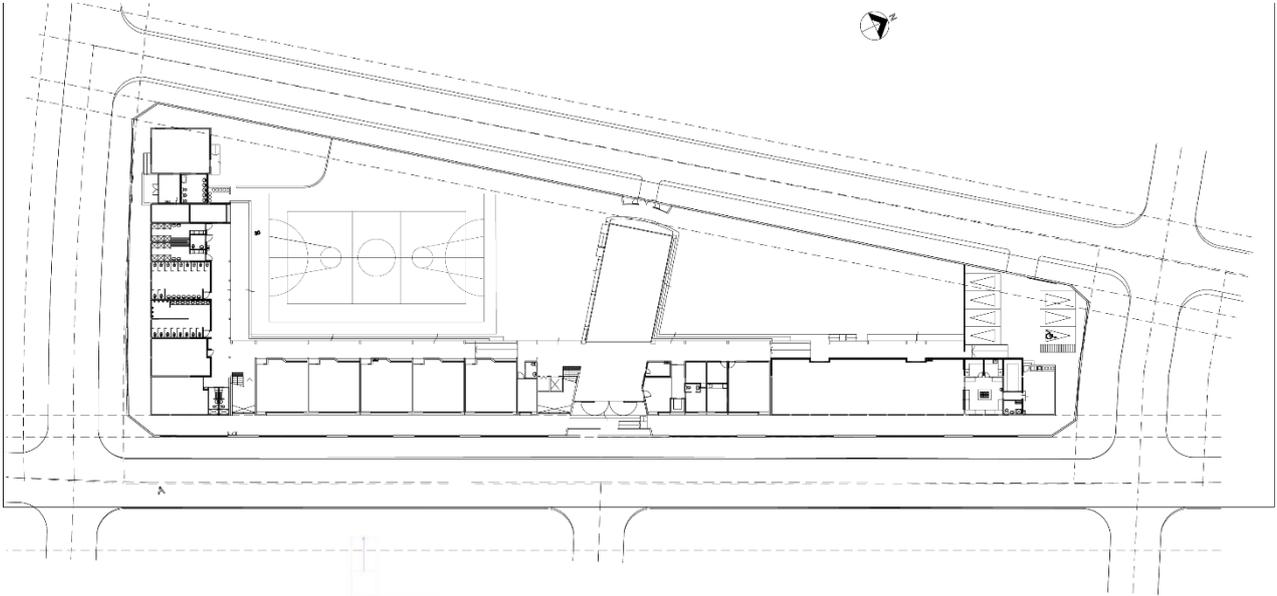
Planta Liceo municipalizado Araucanía, San Ramón, en base a planos originales
